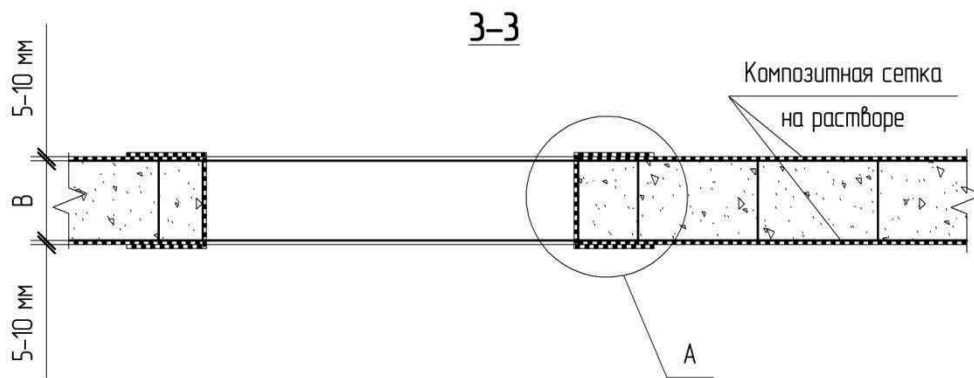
Схема вертикального армирования стен композитными сетками
